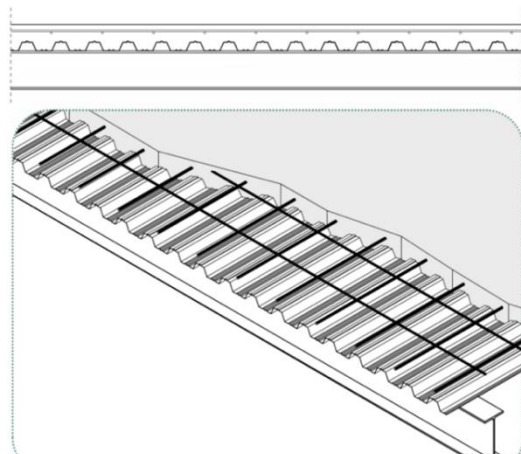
Detalle de forjado unidireccional de chapa colaborante con hormigón.
